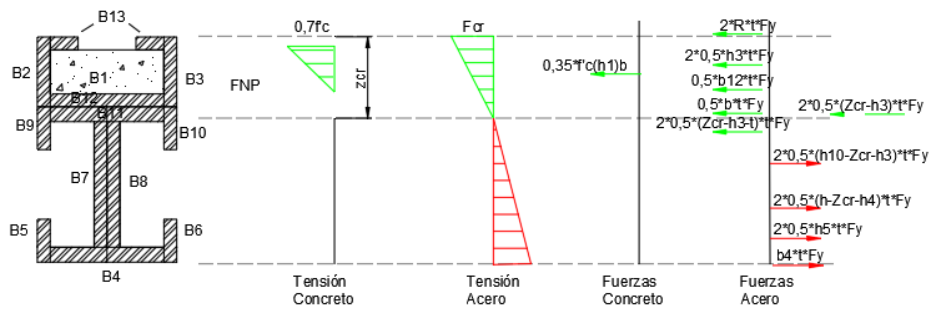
Distribución de tensiones y fuerzas en la Sección N°8 en el rango plástico.
